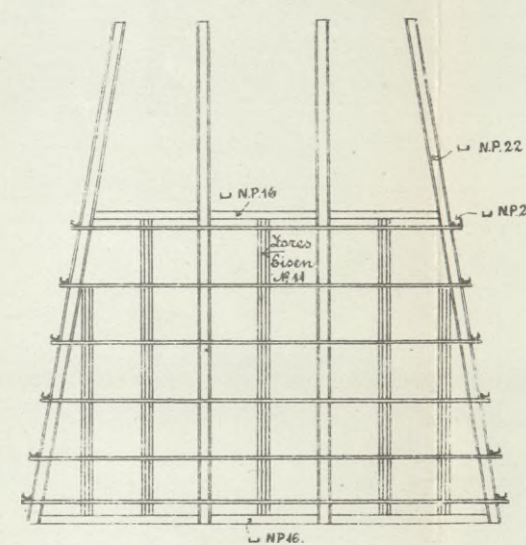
Grundriss eines mit Blöcke gefüllten,
